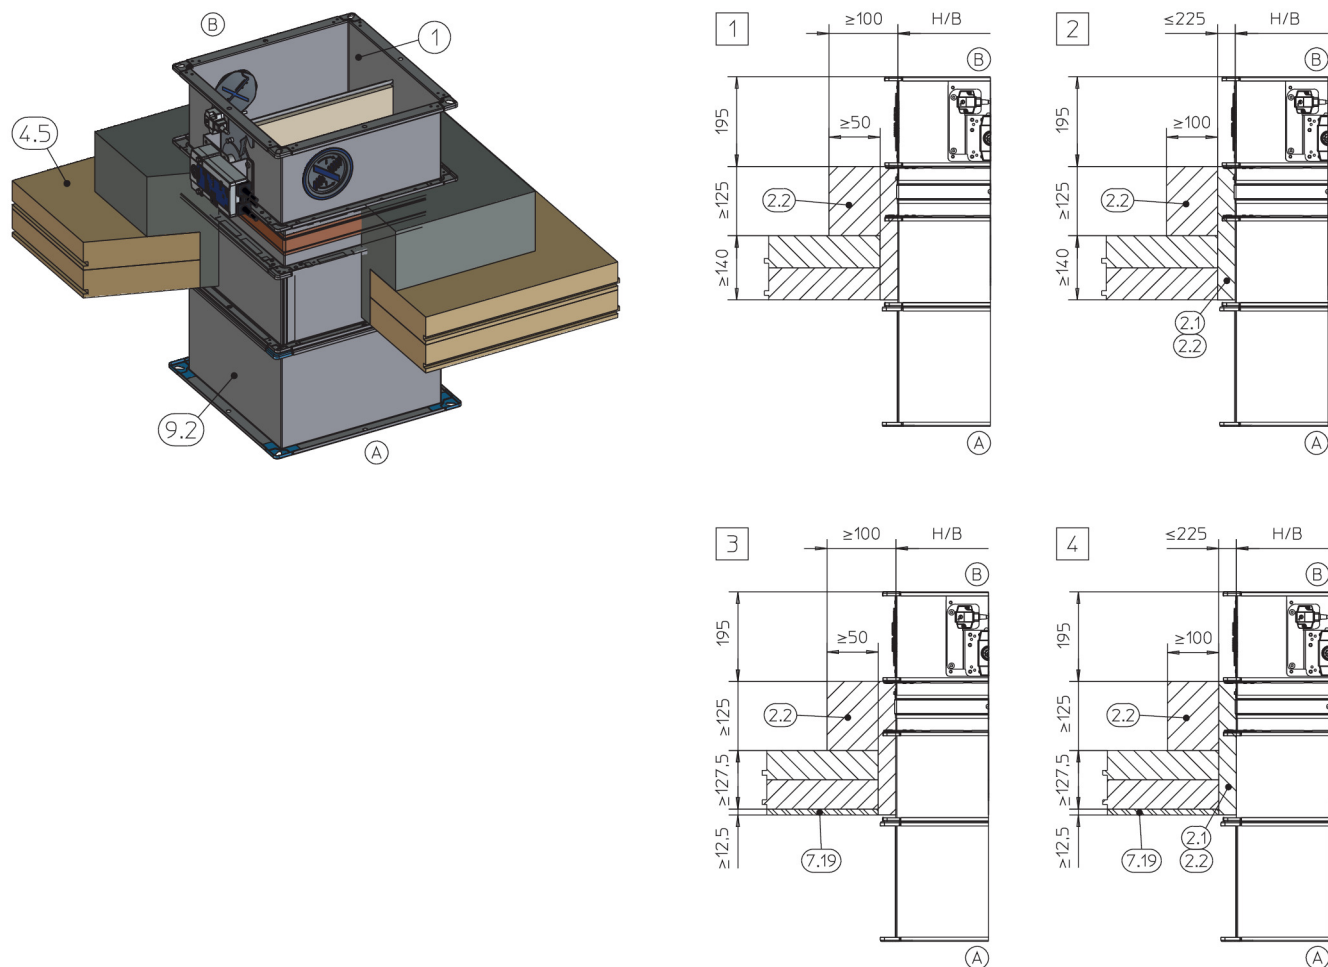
installazione a base di malta in soffitto a soletta solido in collegamento con soffitti con travi di legno/laminate, verticale (figura esemplificativa, utilizzabile per altri modelli di soffitto con travi di legno)
